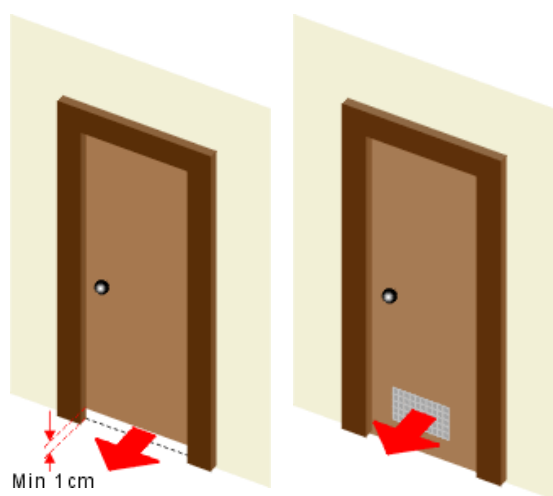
Transfert d'air au travers d'une porte ou par détalonnage
